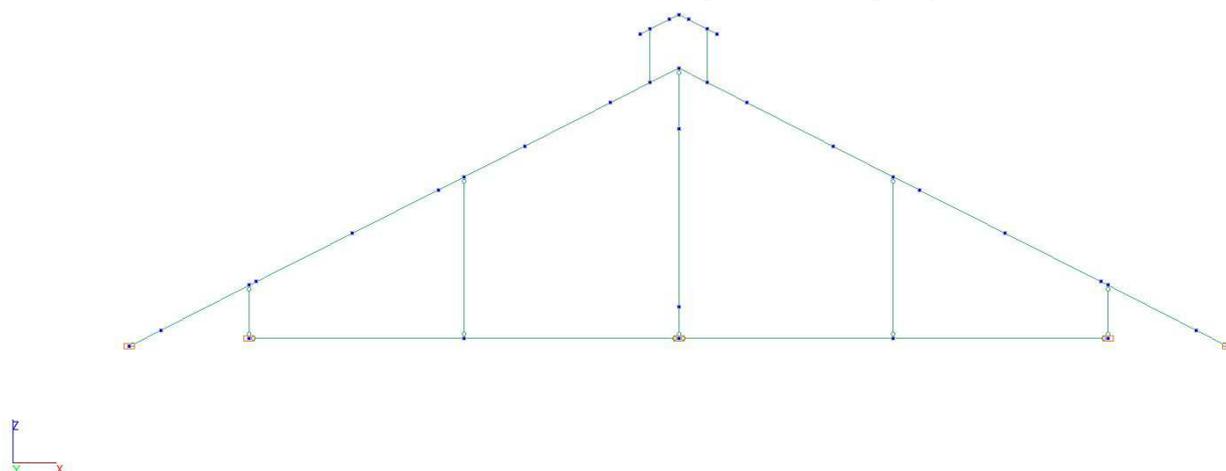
Расчётная схема стального каркаса покрытия здания в осях 1-3/А-В.
